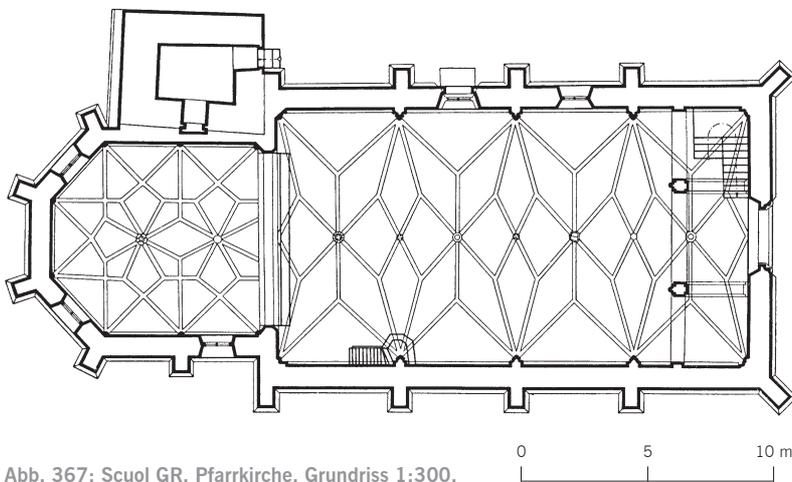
Scuol GR, Pfarrkirche. Grundriss 1:300.
